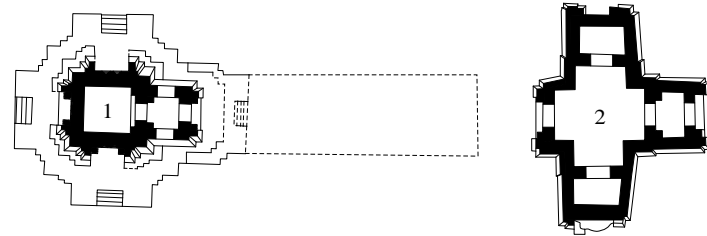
Plan de la chapelle de l'hôpital Est d'Angkor Thom
